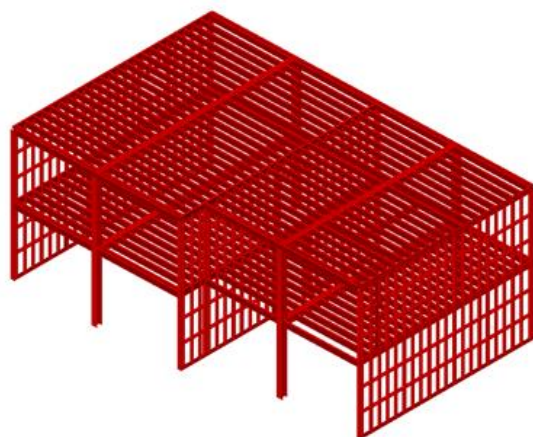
Sistema Metálico Misto (LSF + Construção metálica tradicional)
